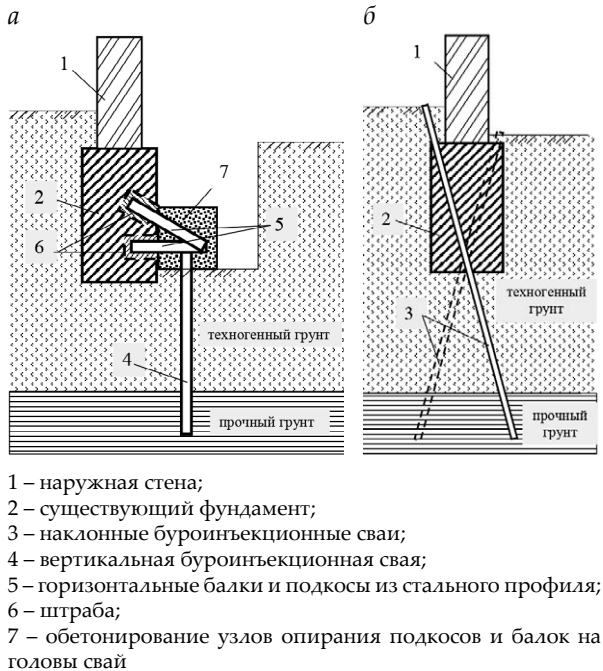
Схемы усиления фундаментов существующих зданий буроинъекционными сваями:
